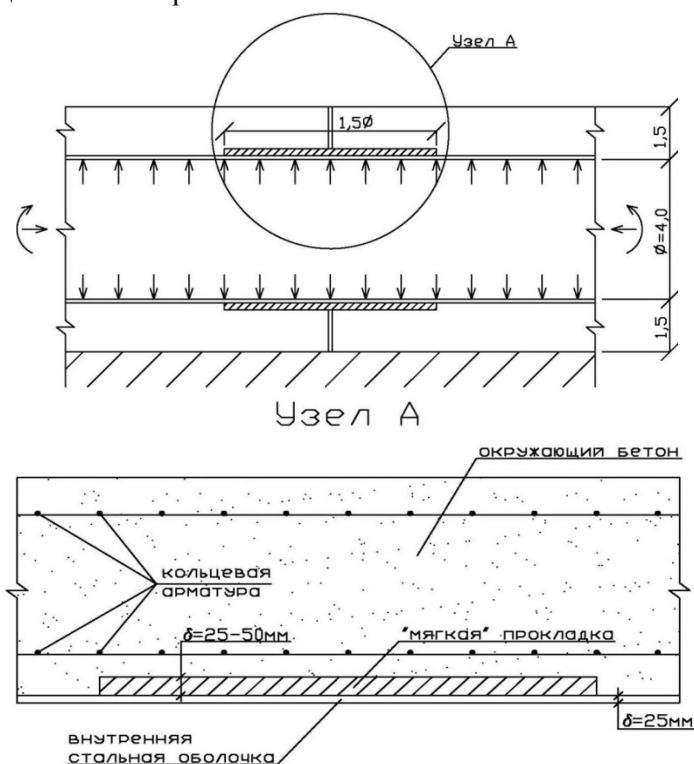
Схема фрагмента сталежелезобетонного напорного водовода, включающего компенсационный участок
